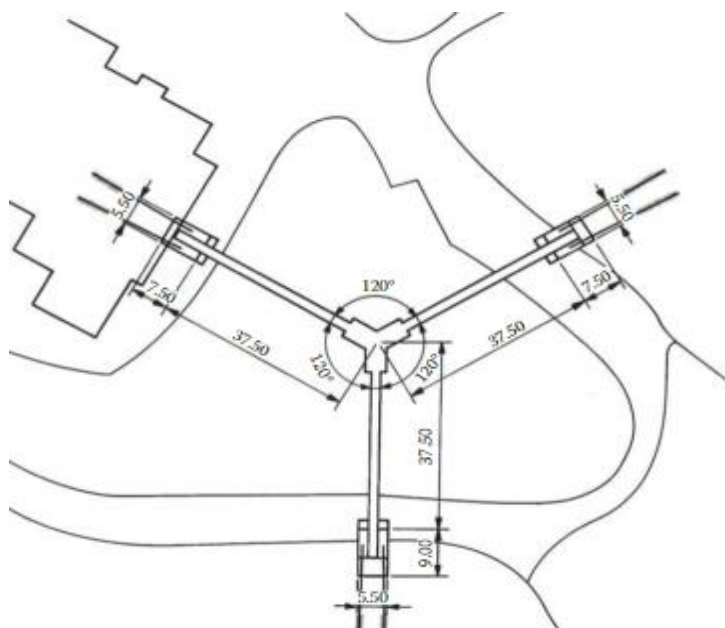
Kikko Bridge: Vista em planta [5]
